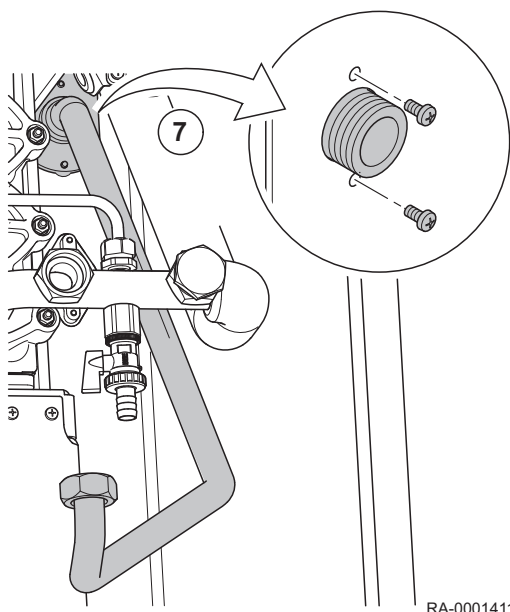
Retirer le bouchon aveugle et la plaque du capot arrière
